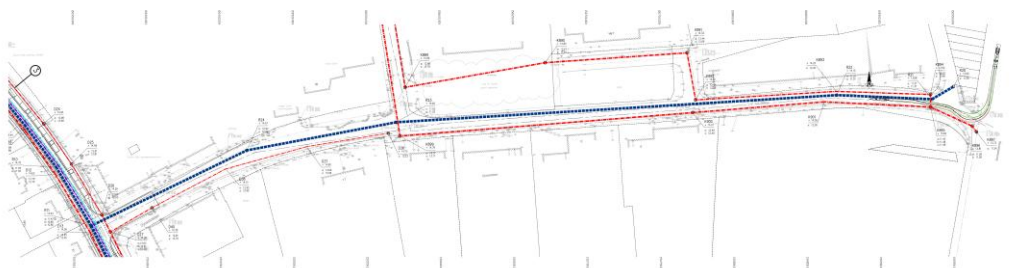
Plantekening van de riolering en het warmtenet in het plangebied (deel 4). Bron: opdrachtgever.
